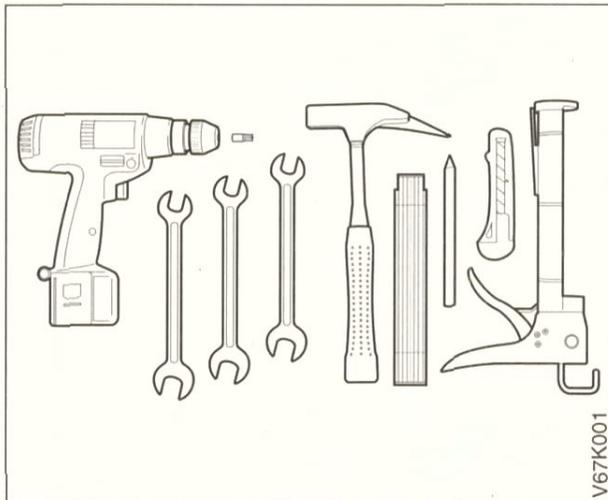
Montage-Werkzeuge: Zollstock, Bohrmaschine, Kreuzschlitz-Bit PZ2, 3 und Maulschlüssel in den Größen 16, 19, 24 sowie Hammer, Teppichmesser und Silikonspritze (ggf. Flex mit Steinscheibe).
